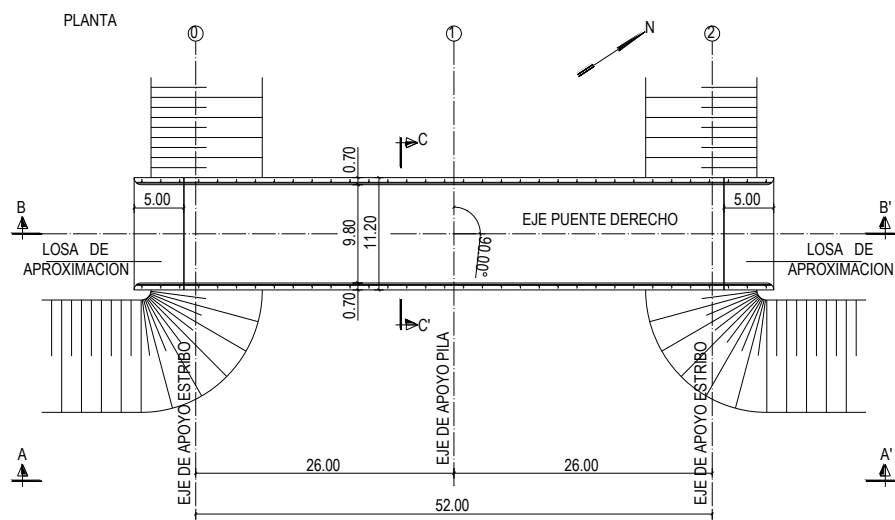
Planta del puente derecho ubicado sobre Avenida Benjamín Aráoz (P2).
